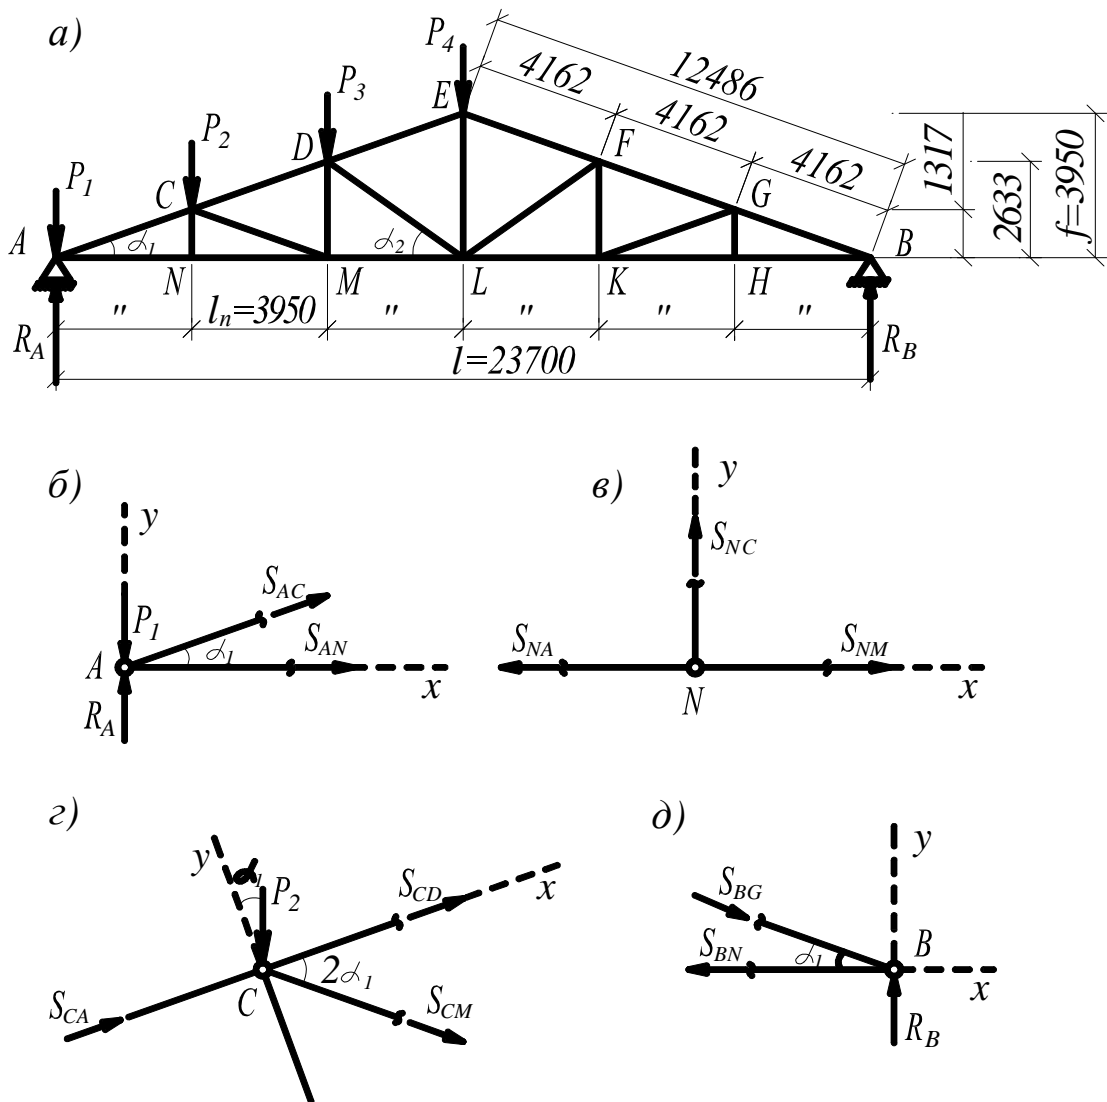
Определение усилий в стержнях фермы методом вырезания узлов:
